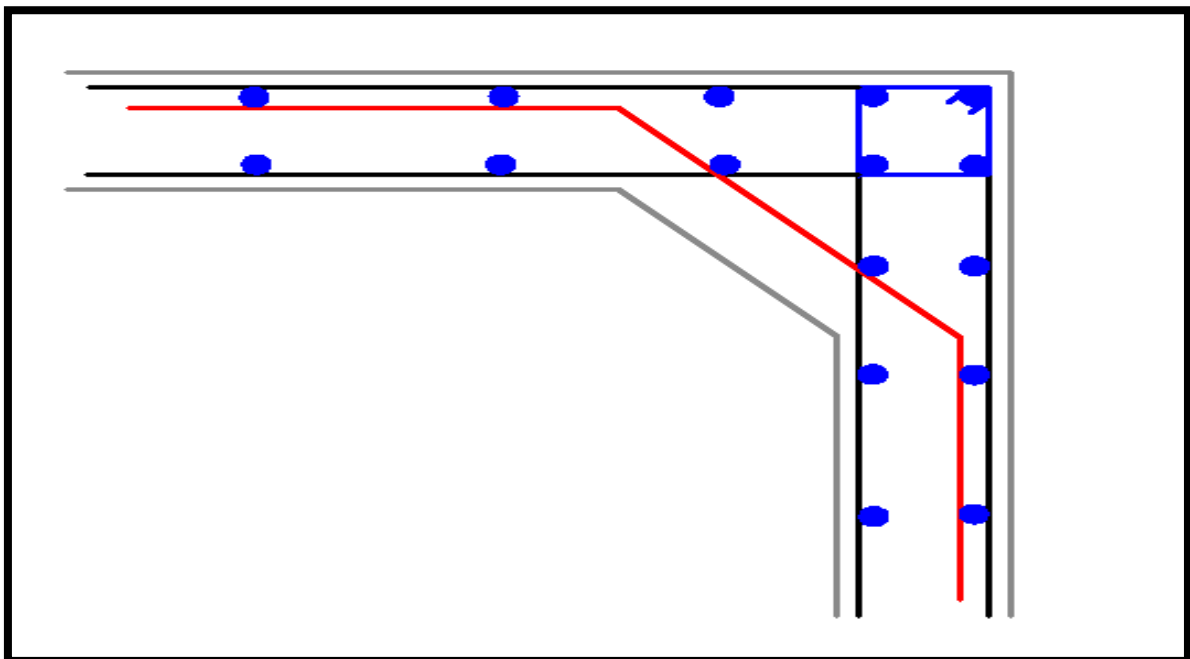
Ferrailage du gousset supérieur (tablier-piédroits)
